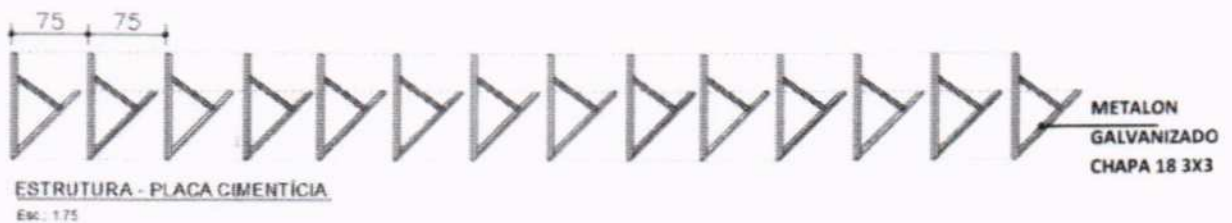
Detalhamento da estrutura. Metalon 3x3 chapa 18.
